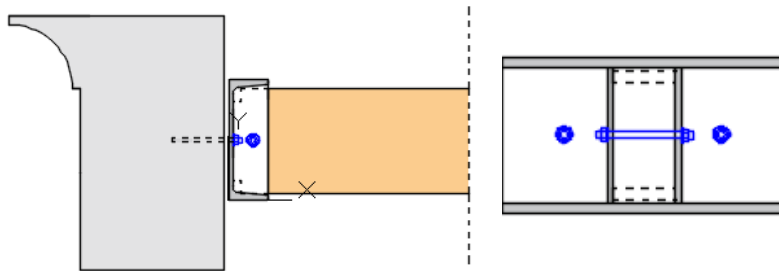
Detalhe da ligação Alvenaria-UPN e viga de Glulam-UPN
